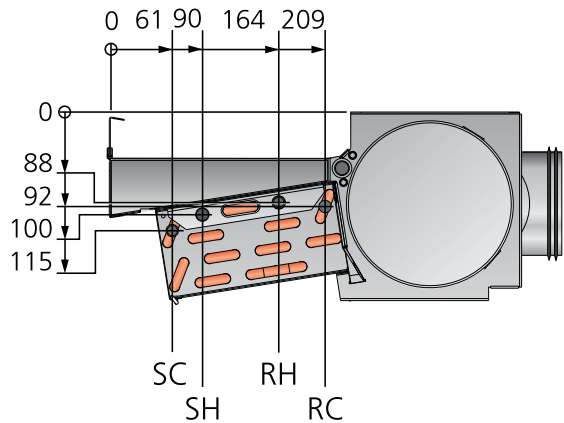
Rohranschlüsse für die Länge 1.000 mm
